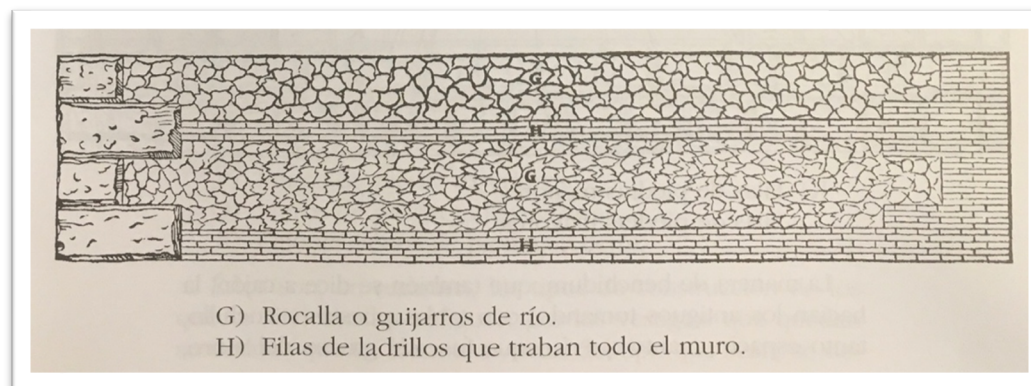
Sistema constructivo para muros de mampostería con piedras toscas de monte o de río.
